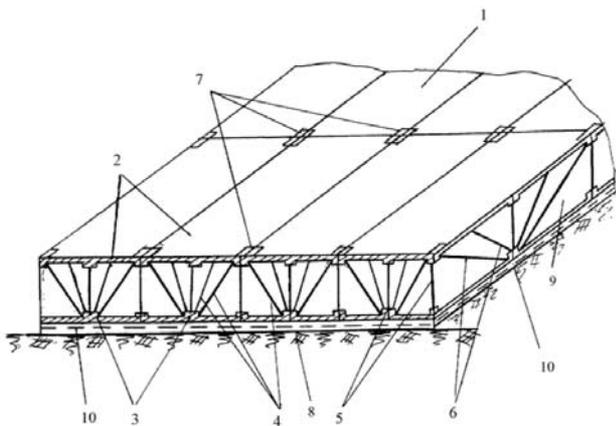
Общий вид сталежелезобетонной фундаментной платформы: 1 – фундаментная платформа; 2 – верхняя железобетонная плита; 3 – нижняя железобетонная плита; 4 – металлический пространственный шпренгель; 5 – стойка; 6 – раскосами; 7 – закладные детали; 8 – поверхность грунта; 9 – продуваемое подполье; 10 – скользящий слой
